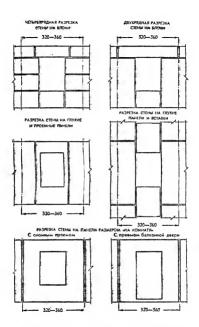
Схемы разрезки наружных стен на блоки и папели.
